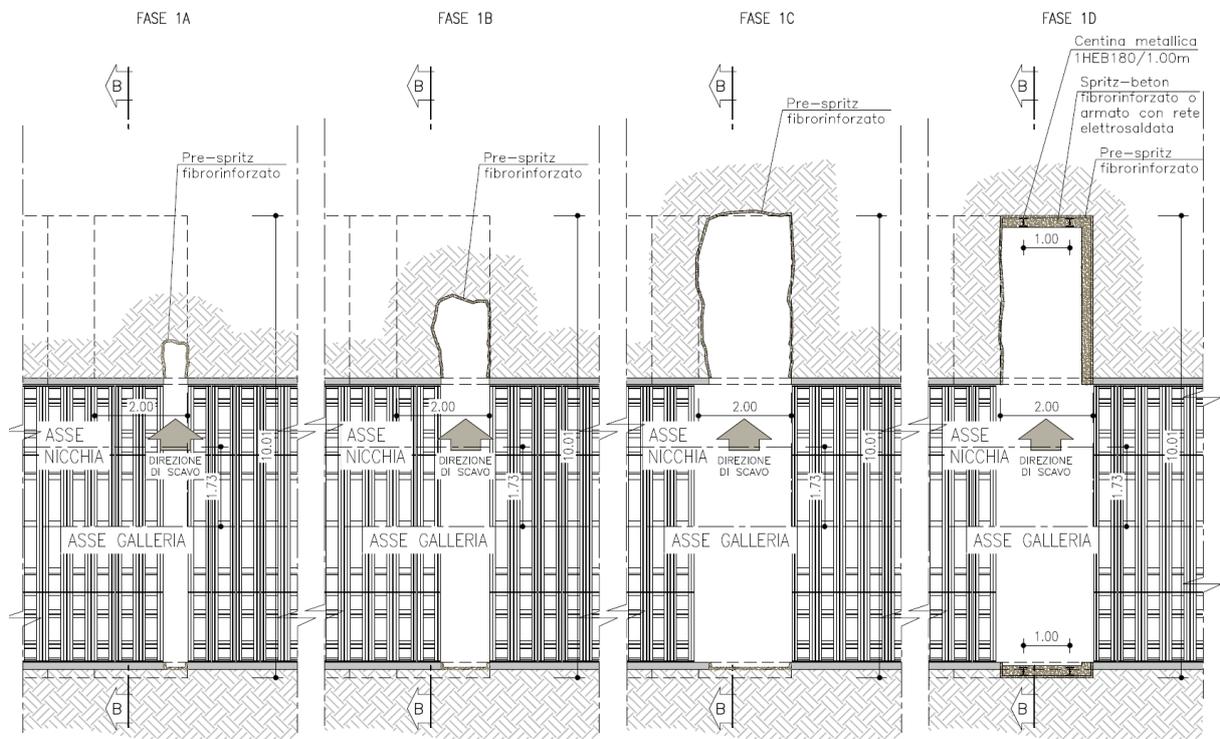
Sezione S2-2 in corrispondenza di sezione cunicolo F5 – Esecuzione del primo sfondo laterale
